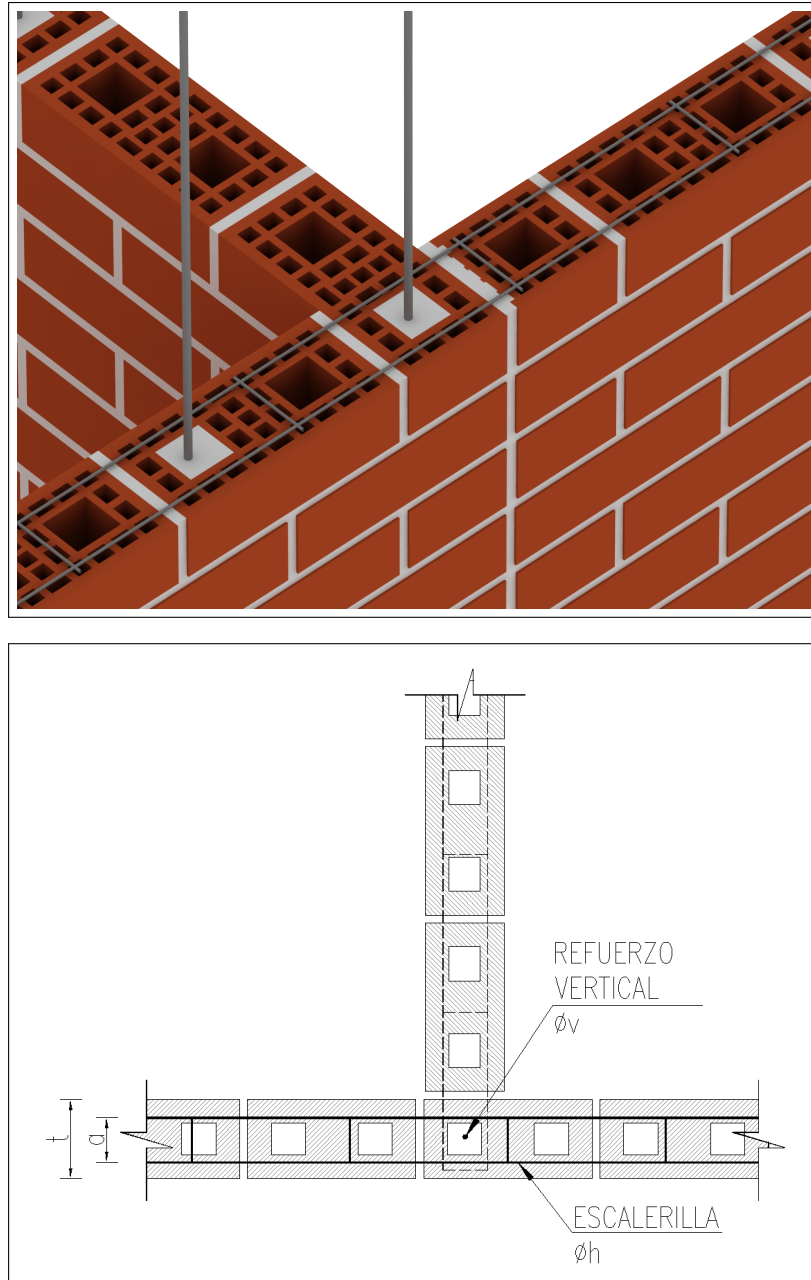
Detalle del refuerzo horizontal del muro que continua en un encuentro de muros en T.
